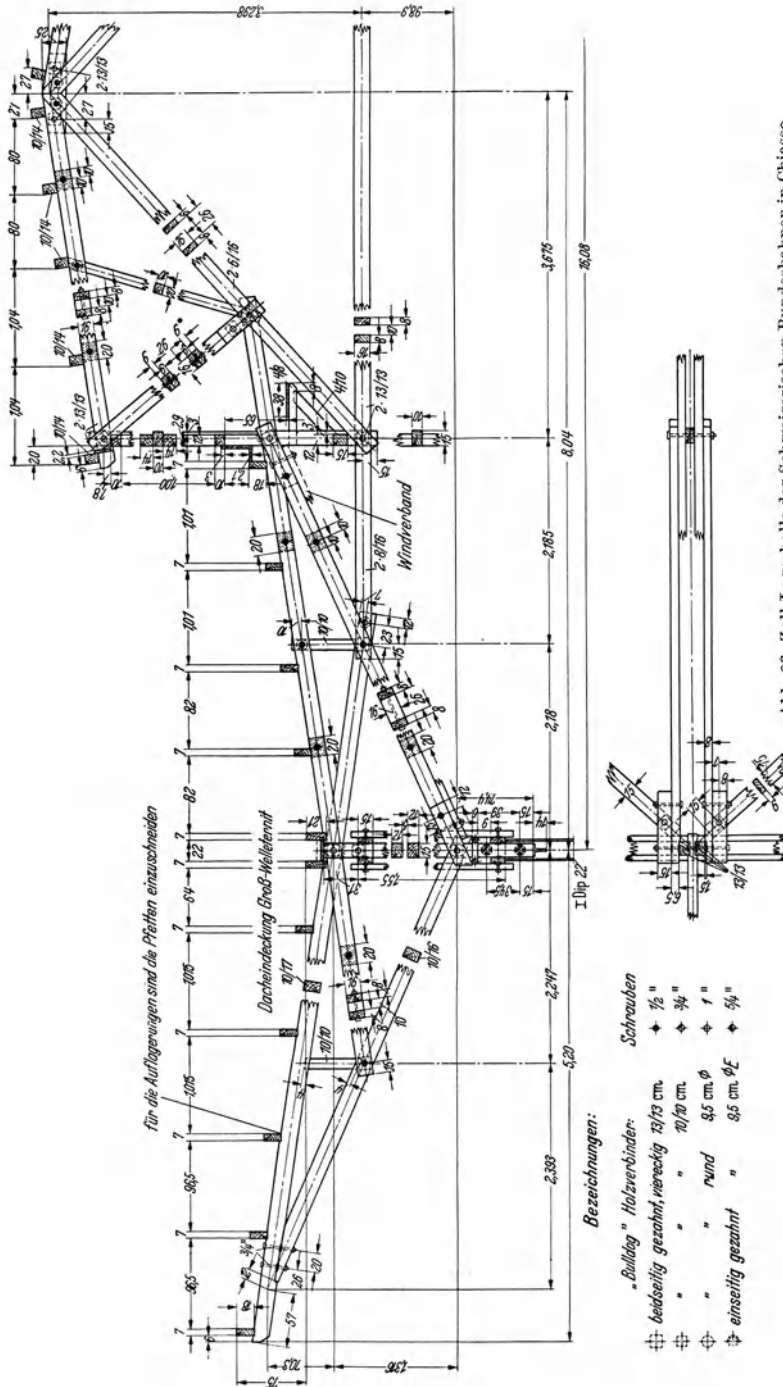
Zoll-Lagerhalle der Schweizerischen Bundesbahnen in Chiasso.
